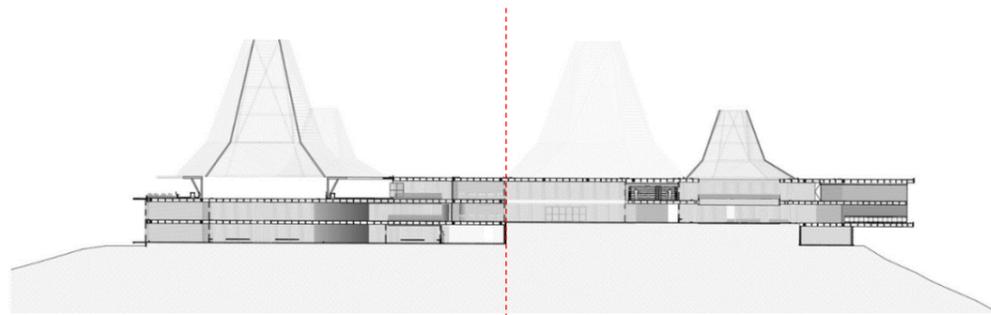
Corte Transversal 2 - Fuente: Arch Daily
